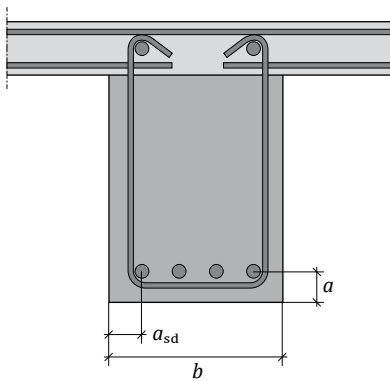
Mindestbreite und Mindestachsabstände eines Stahlbetonbalkens
